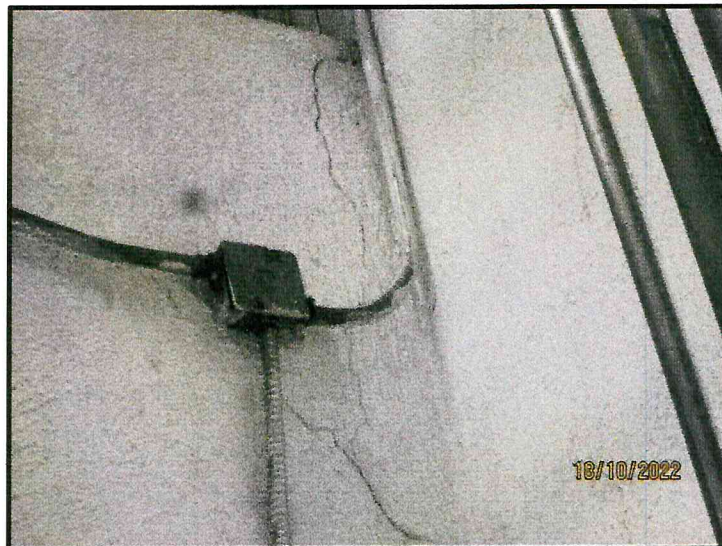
Fisuramiento de cerámico (azulejo) en zona de baños, en intersección de muro no estructural y columna (Vista exterior baño de mujeres)
